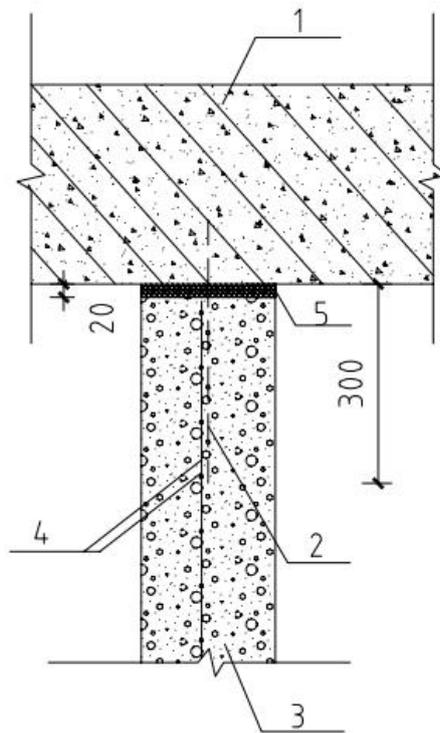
配单层钢丝焊接网的泡沫混凝土墙顶与梁（板）连接示意
